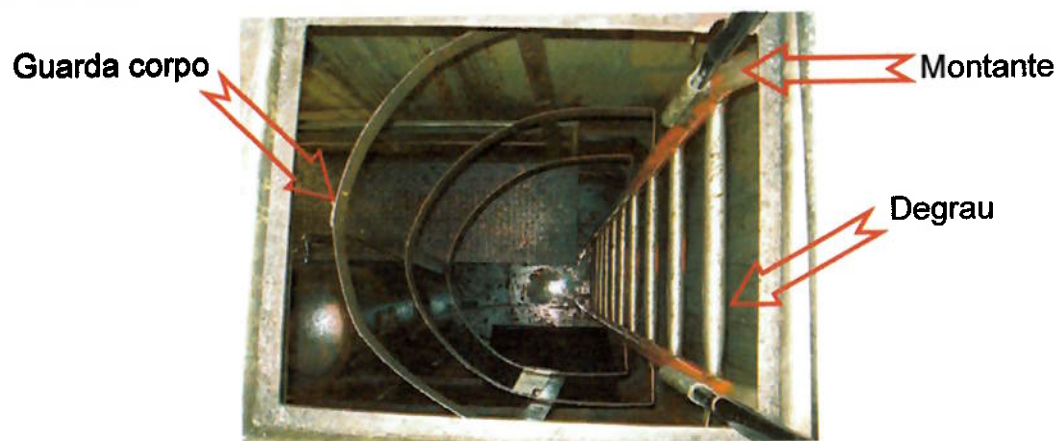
Escada tipo marinheiro vista pelo lado de fora do porão
